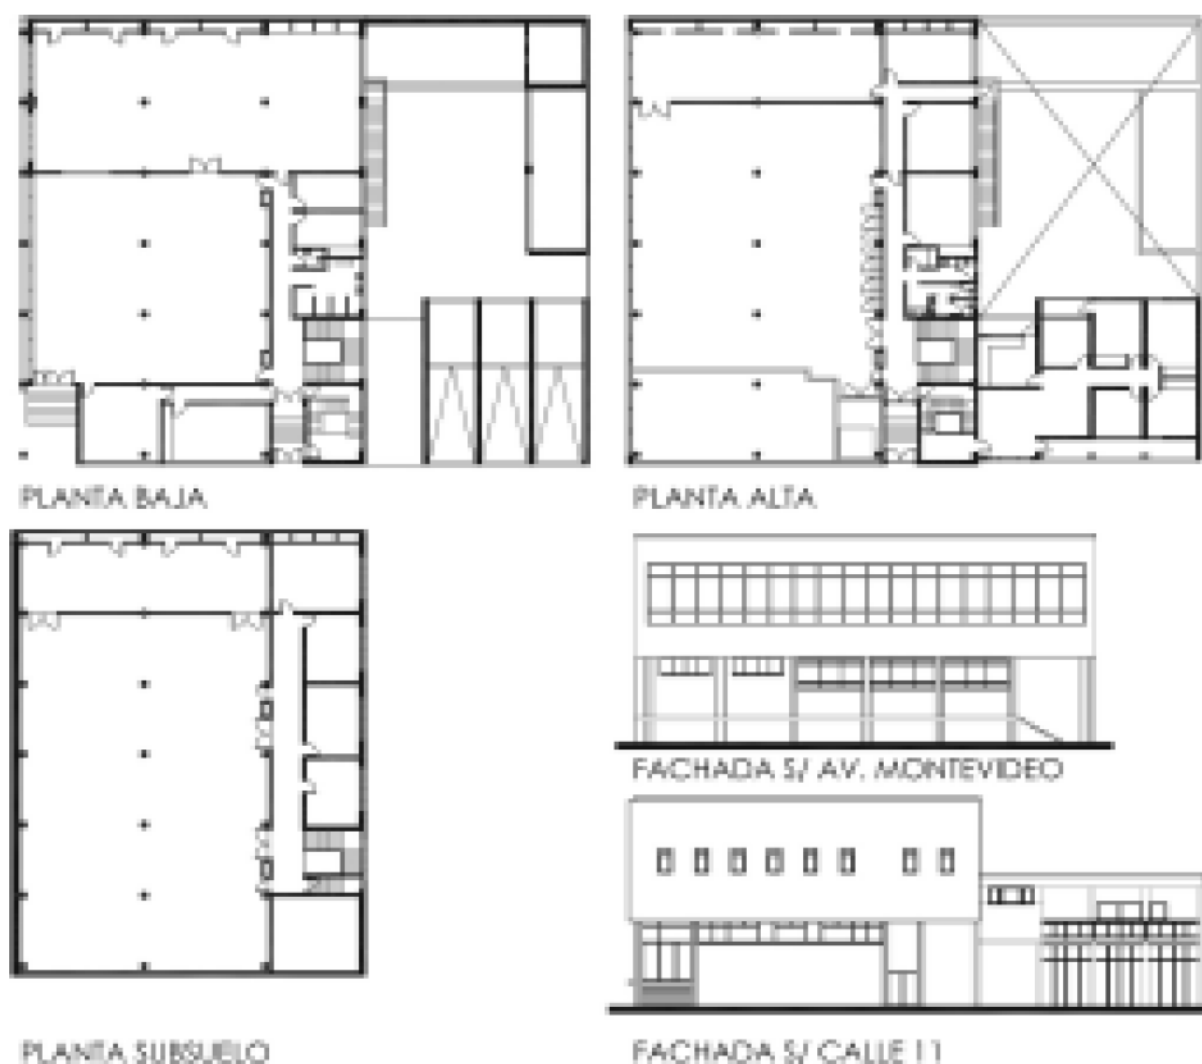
Plantas y fachadas del Correo de Berisso
